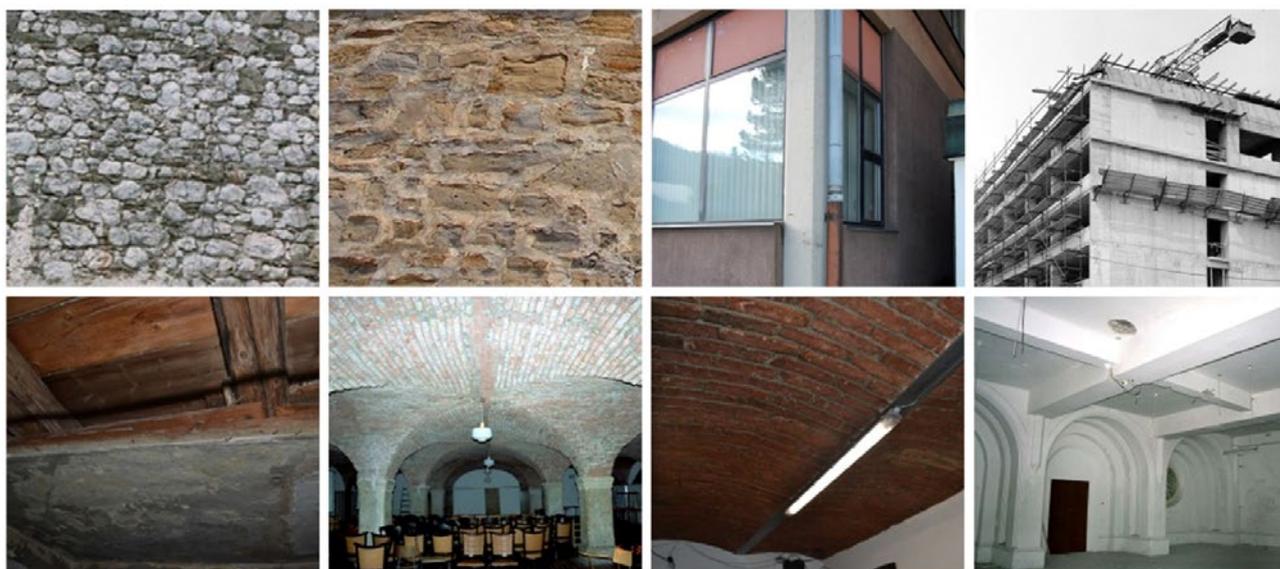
Principali soluzioni costruttive dell'edificato storico sloveno; in senso orario: muraure in pietra irregolare, muratura in pietra squadrata, telaio in calcestruzzo armato, pareti in calcestruzzo armato, solai in legno, volte in laterizio, solai a travi in acciaio e voltine, soletta nervata in calcestruzzo armato – © 2021, M. Lutman.
